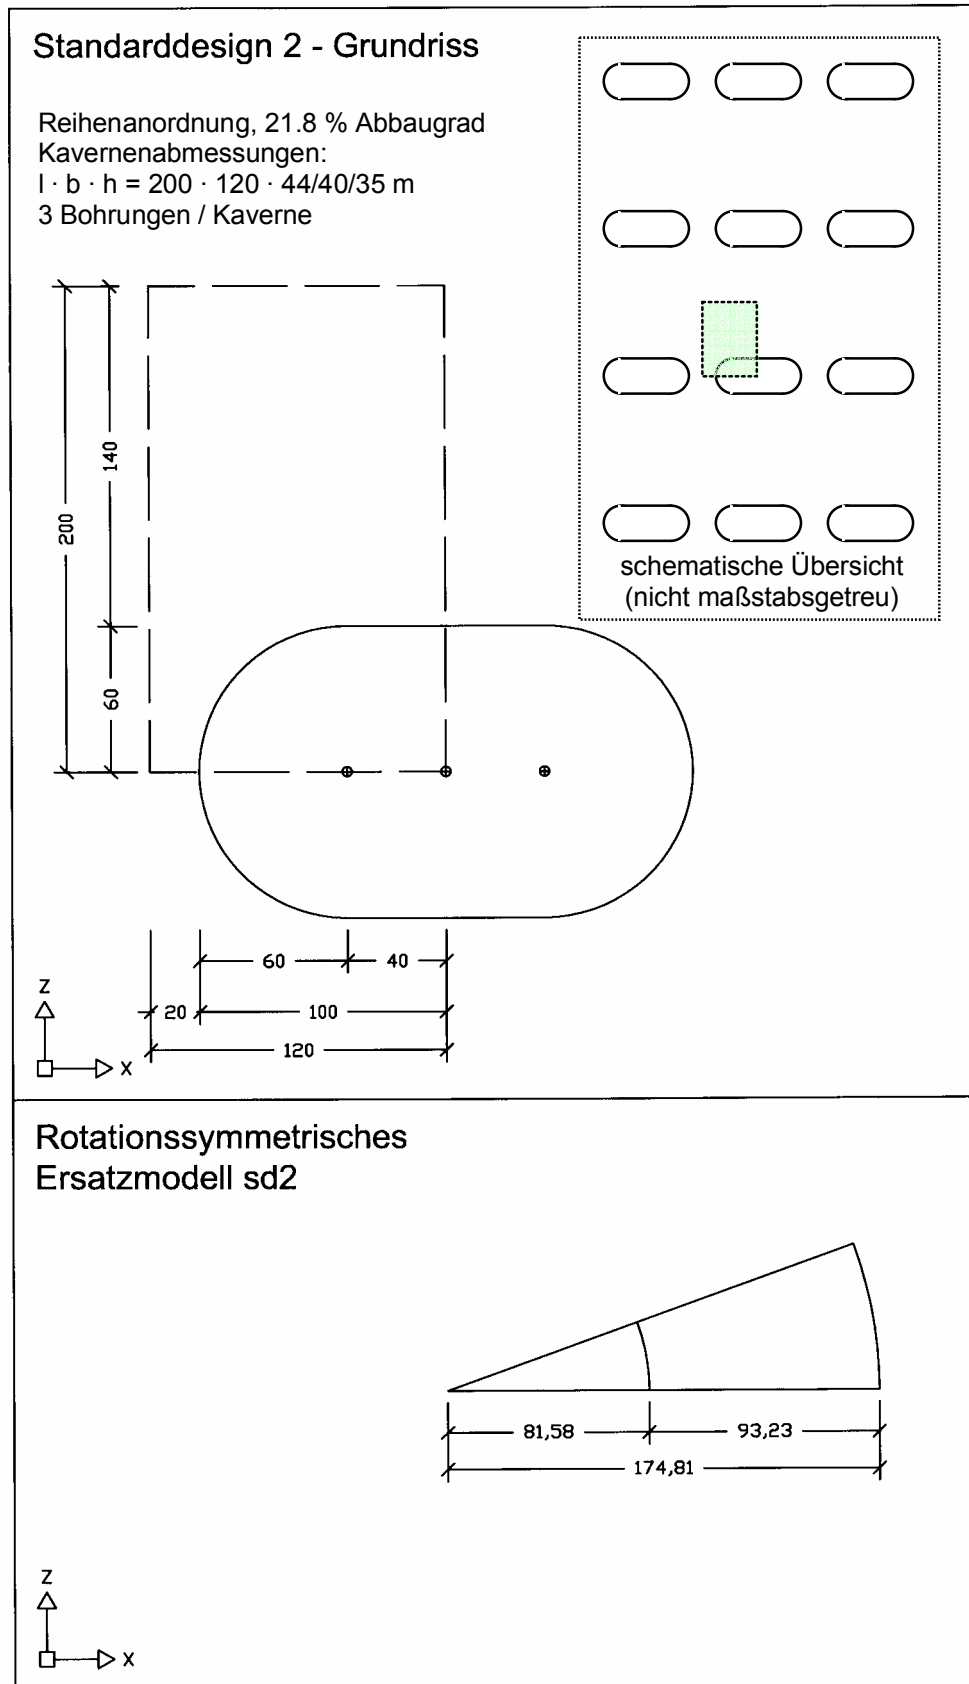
Standarddesign 2 – Grundriss und rotationssymmetrisches Ersatzmodell
